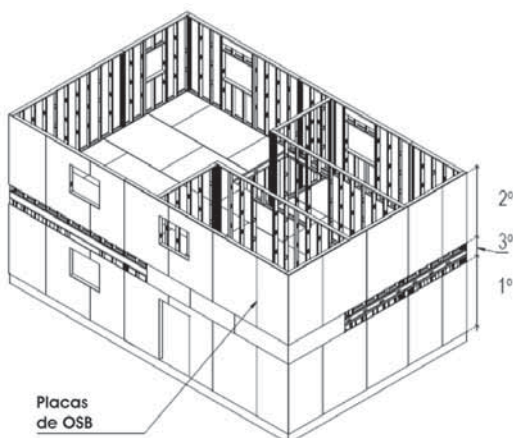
Emplaceamento dos painéis externos. (Adaptado de ConsulSteel, 2002)
